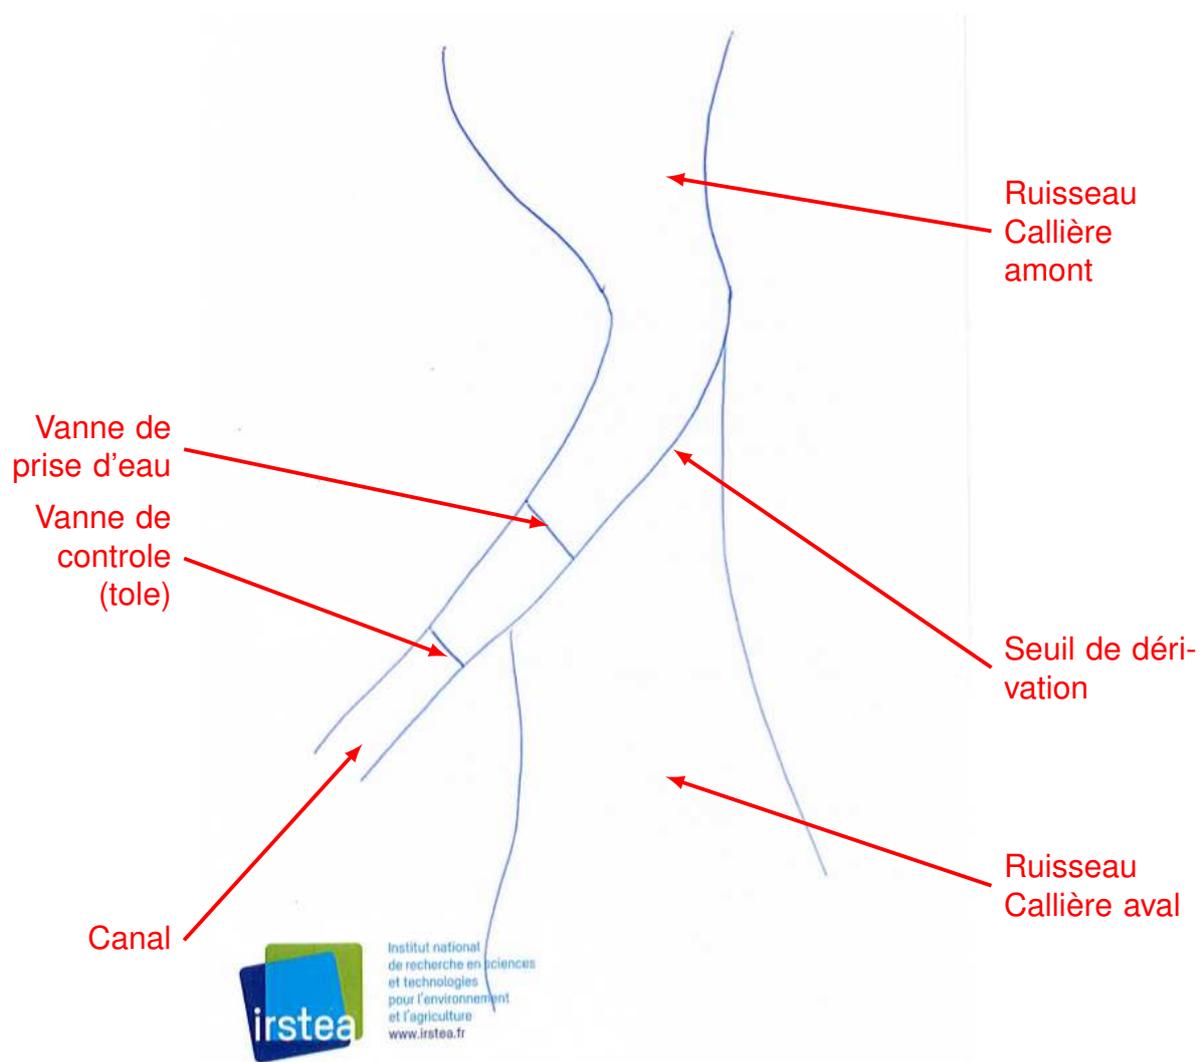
Plan de la prise d'eau Canal de Callière ©IGN
